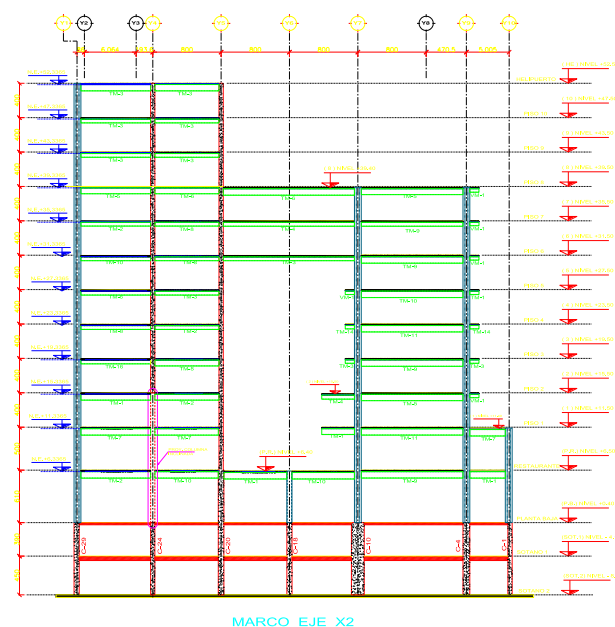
Corte transversal de estructura metálica Complejo City Angelopolis
